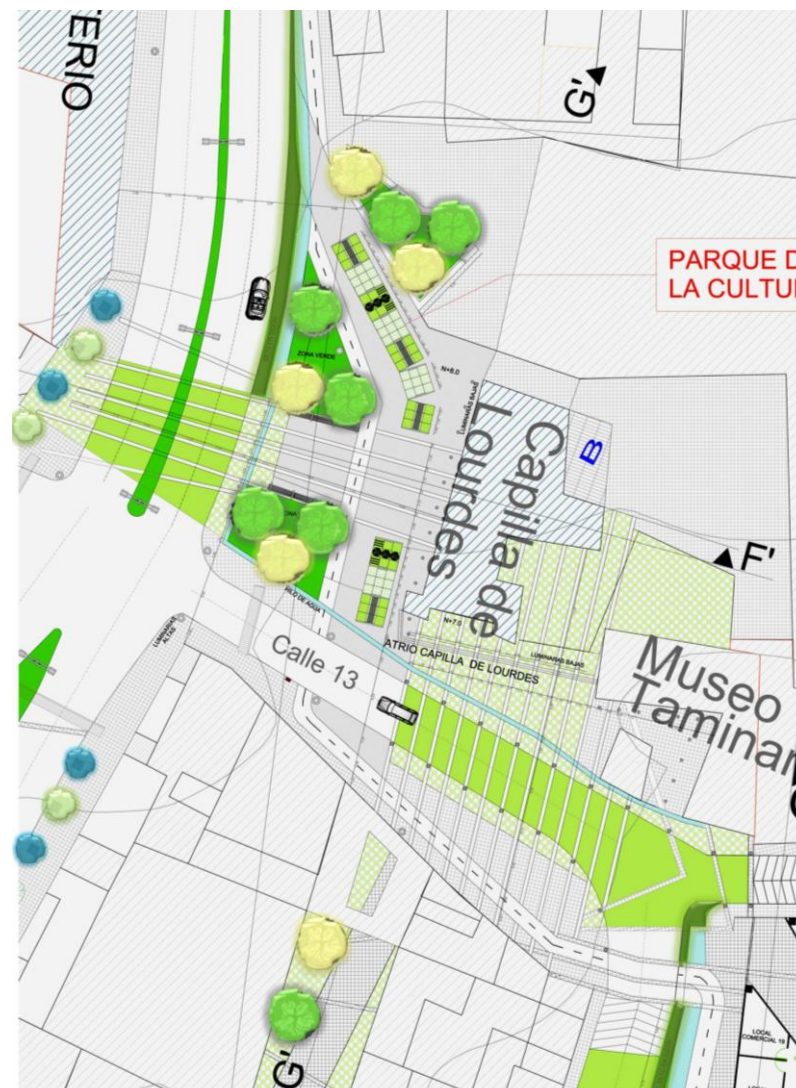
//Planta Fitotectura propuesta Sector de Taminango//
